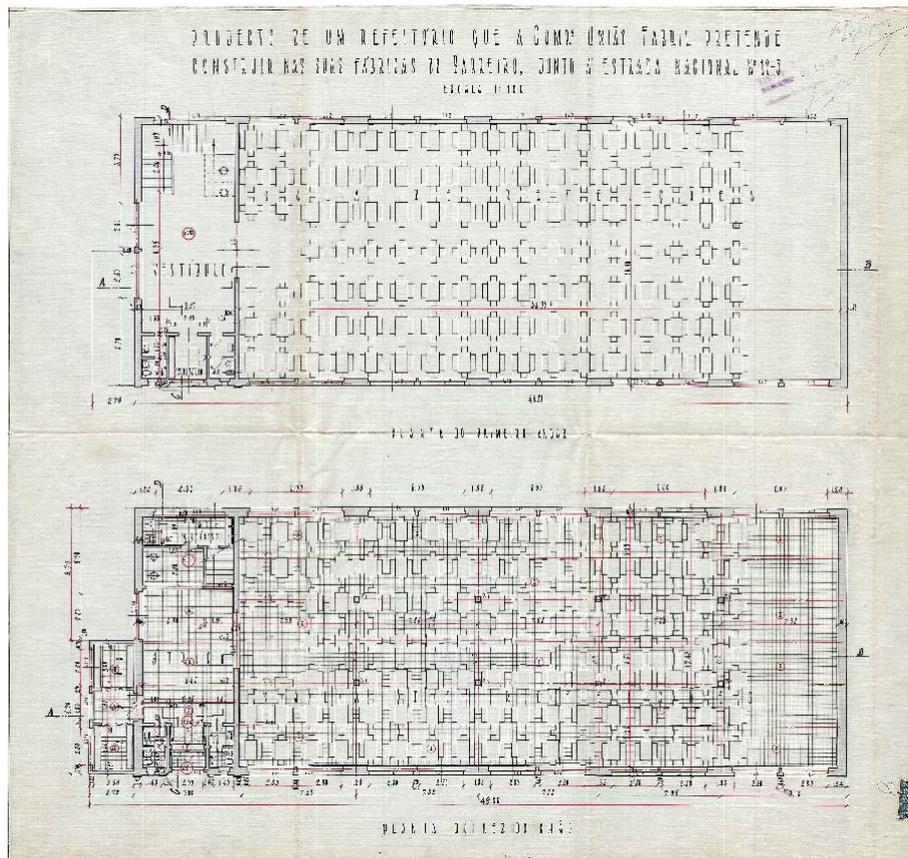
Conjunto de Plantas do Refeitório que a CUF construiu nas suas fábricas do Barreiro
